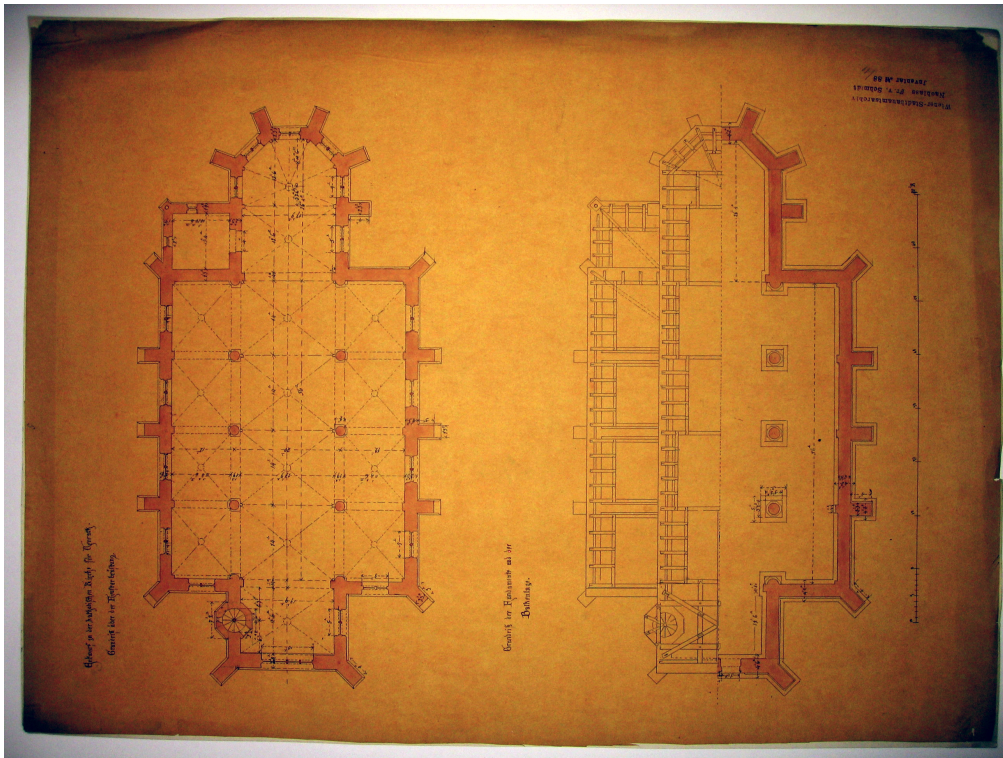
WM, Inv.-Nr. 157.88/11 vereinfachter Entwurf, Grundriss
